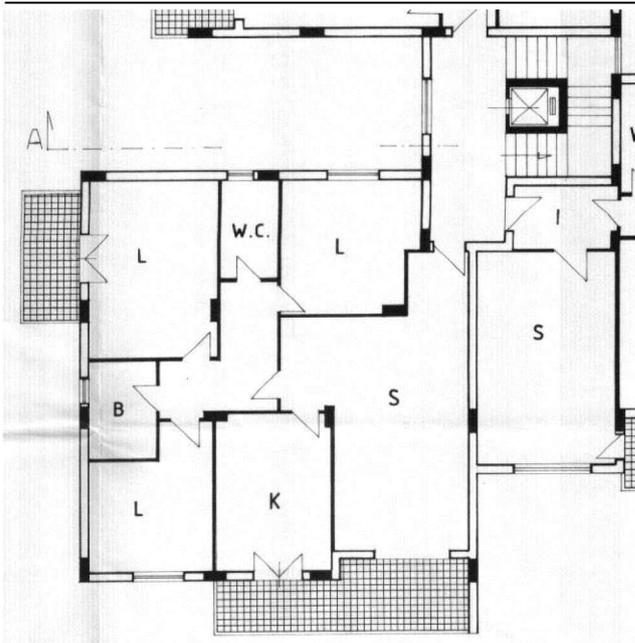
planimetria urbanistica dell'appartamento al quarto piano pignorato secondo la C.E. n.31/88 del 08/03/1988
